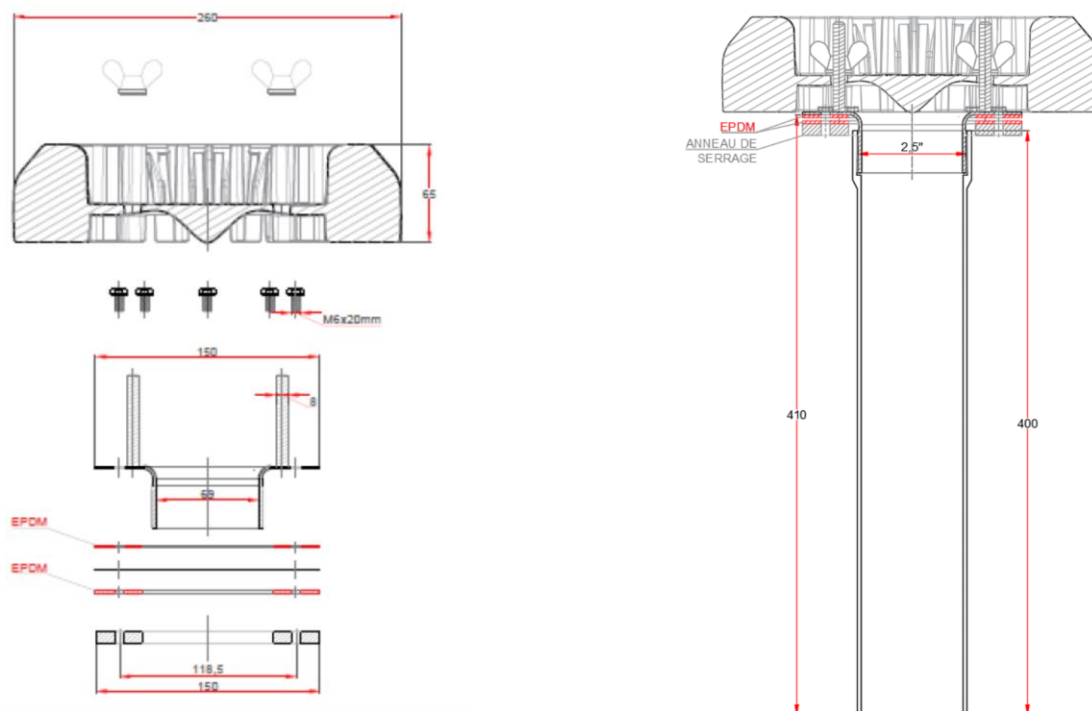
Naissance compatible avec un revêtement d'étanchéité PVC-P non sous-facé ou FPO SARNAFIL® TS 77 bénéficiant d'un Document Technique d'Application
